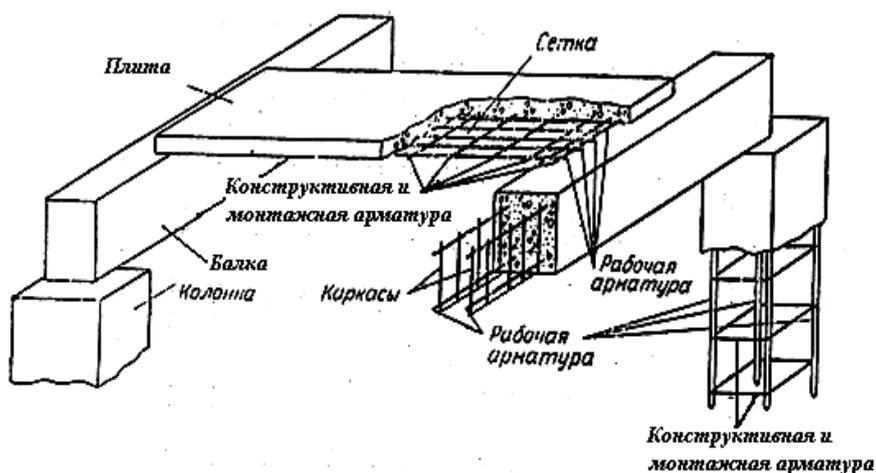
Способ армирования железобетонных элементов каркасами и сетками
